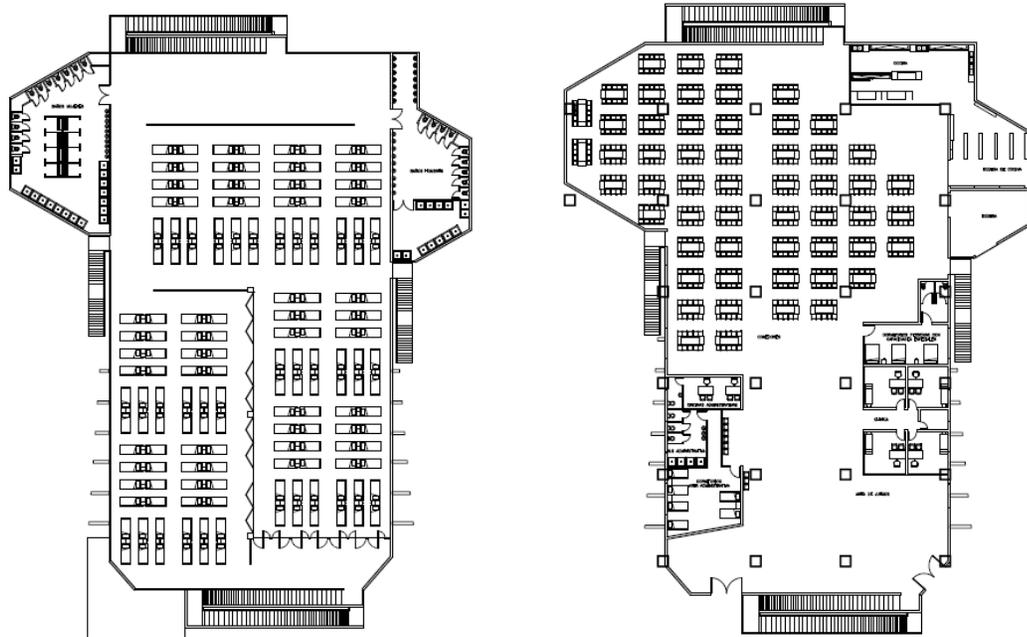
Plantas Arquitectónicas del Edificio para Albergue.
